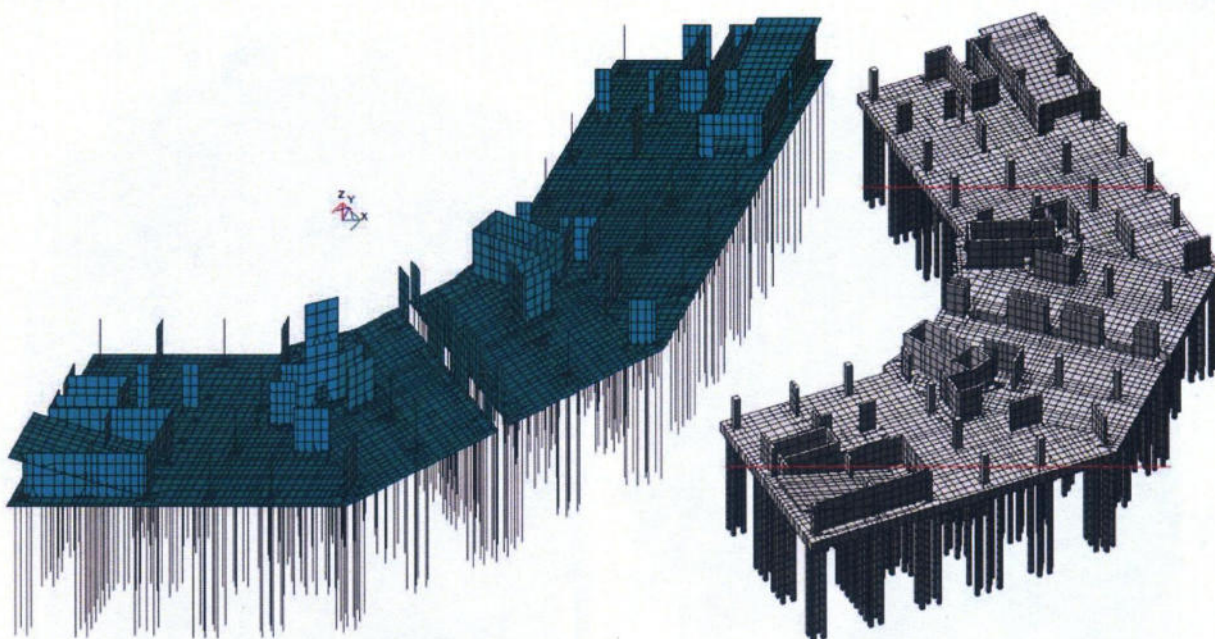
Фрагмент розрахункової моделі. Підземний поверх з ростверком і палями
